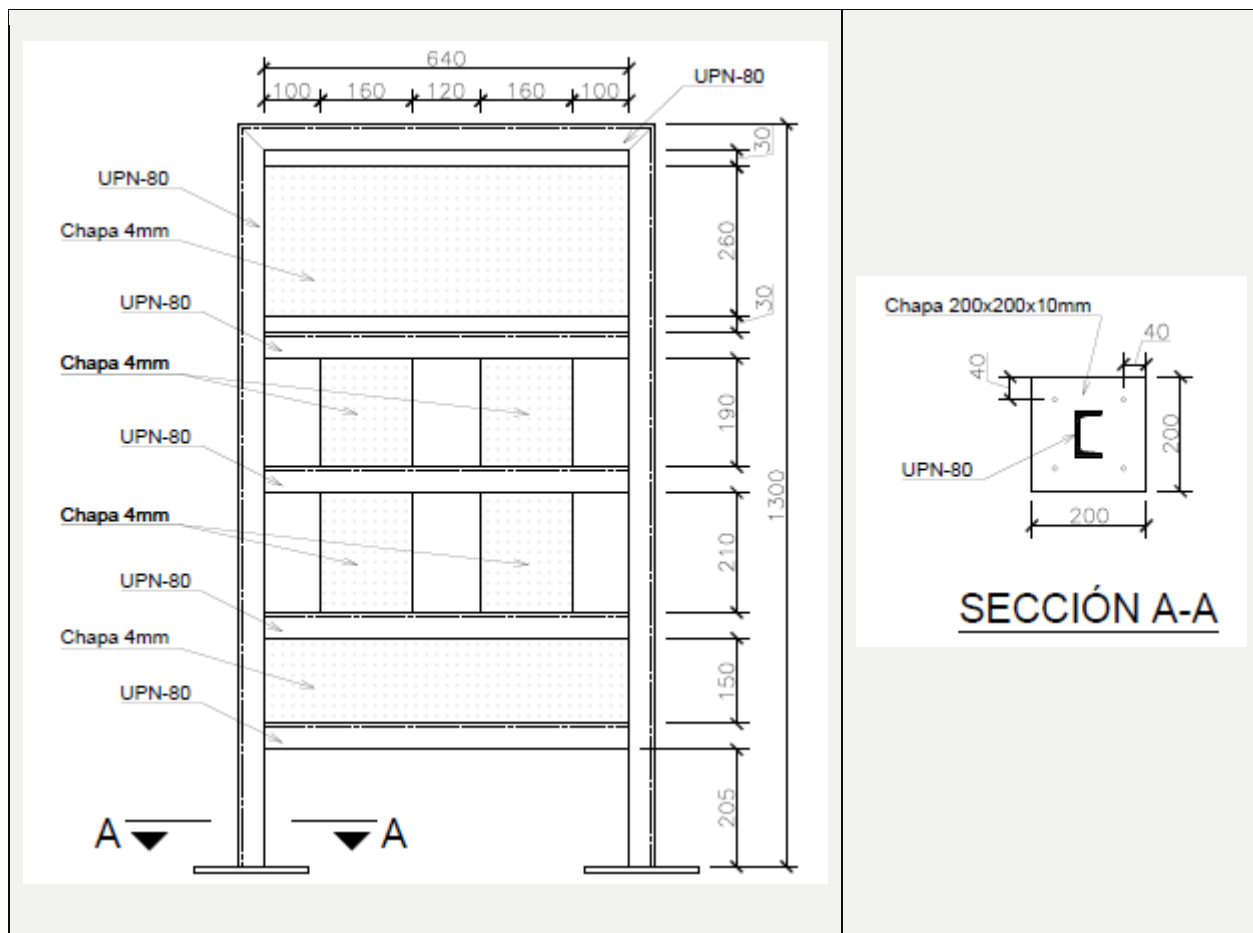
Detalle constructivo del rack de instrumentación que contendrá los FITs y elementos asociados
